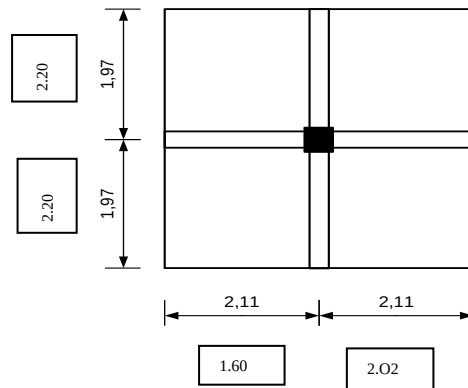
Surface supportant la charge revenant au poteau le plus sollicité.
